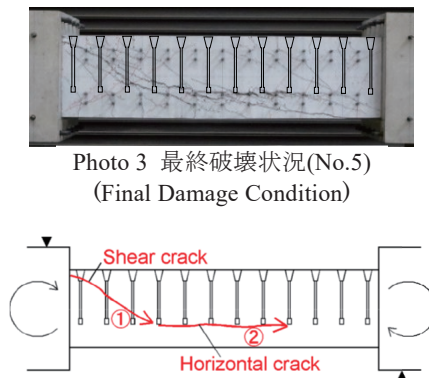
最終破壊状況(No.5) (Final Damage Condition) Fig.7 ひび割れ進展状況 (Progress of Cracking)
